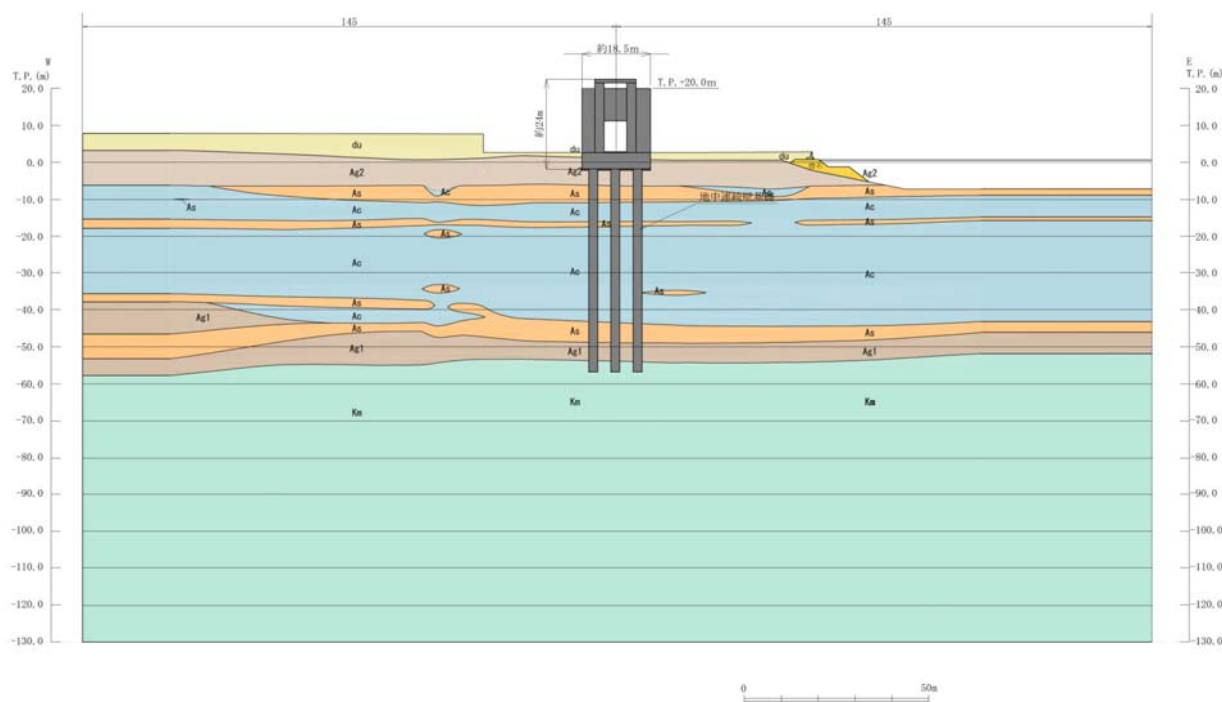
(2) 鉄筋コンクリート防潮壁 評価対象断面図 (②-②断面)
